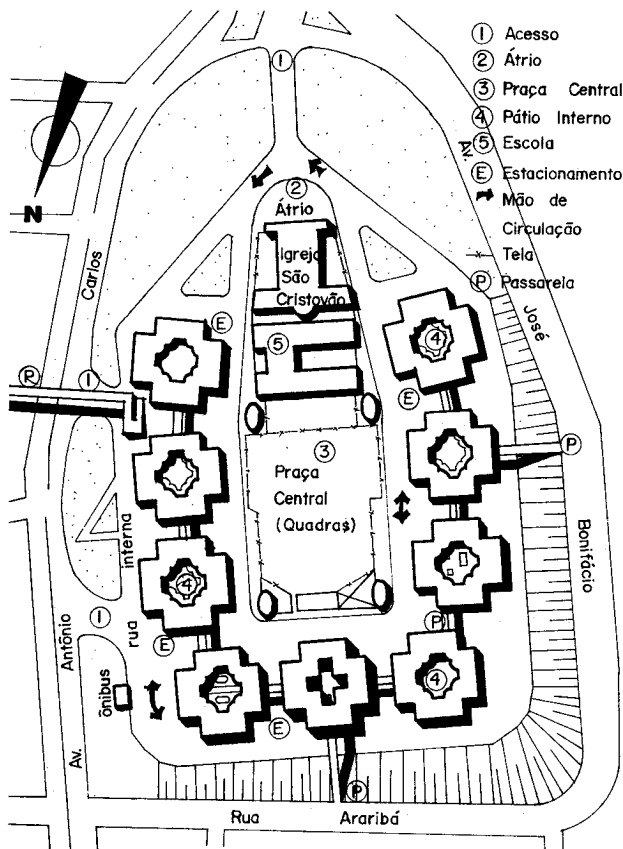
Planta do Conjunto I.A.P.I./Situação atual
